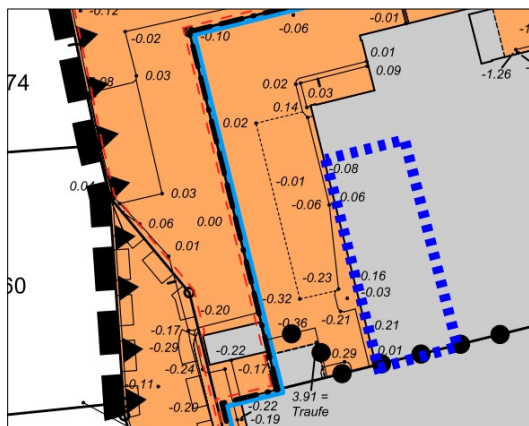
Auszug aus Planzeichnung zur 6. Änderung des B-Planes Nr. 13 – B2K Architekten Stand: 25.10.2023
